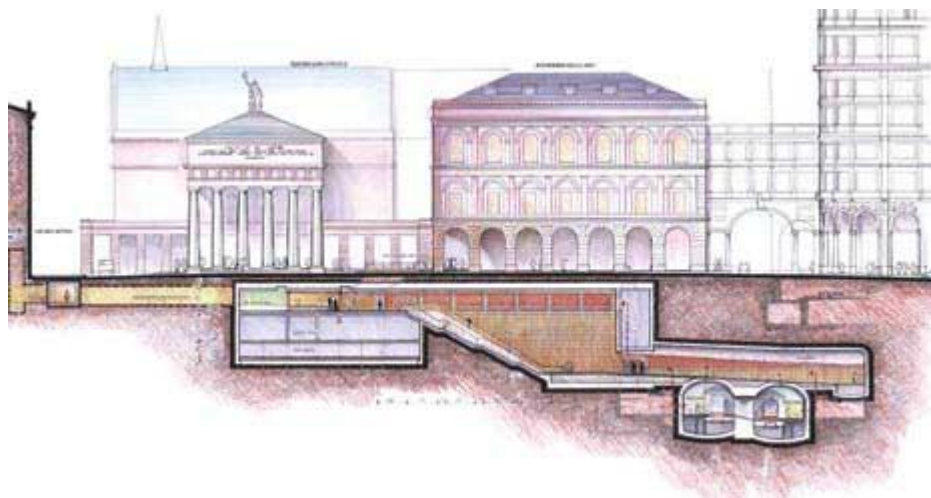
Disegno di progetto della Stazione De Ferrari realizzata dall'architetto Renzo Piano [58].
